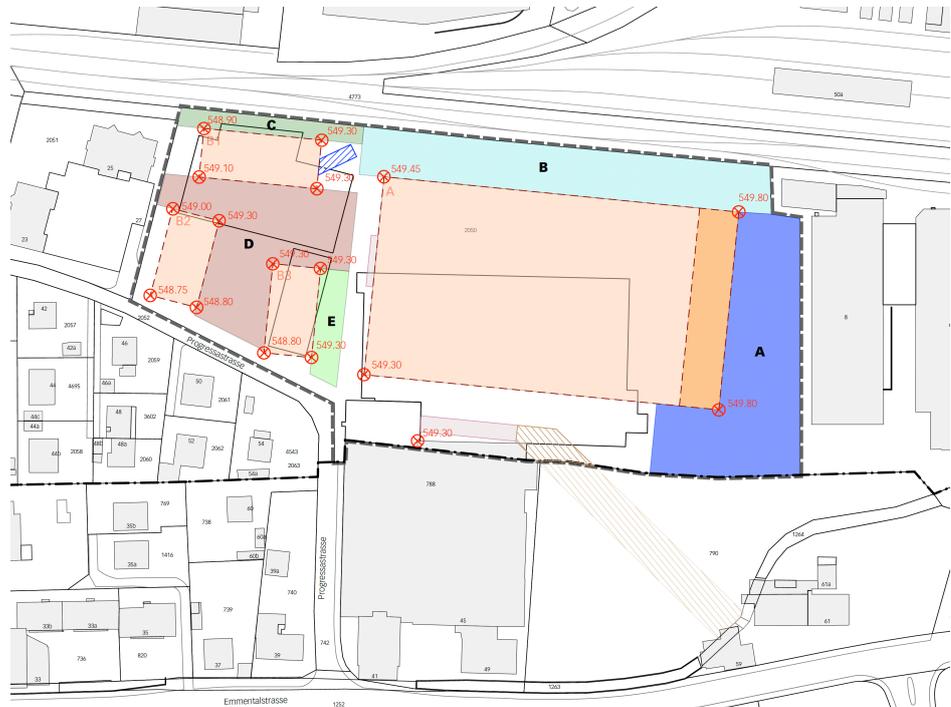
Ausschnitt Plan Hochwasserschutzmassnahmen
